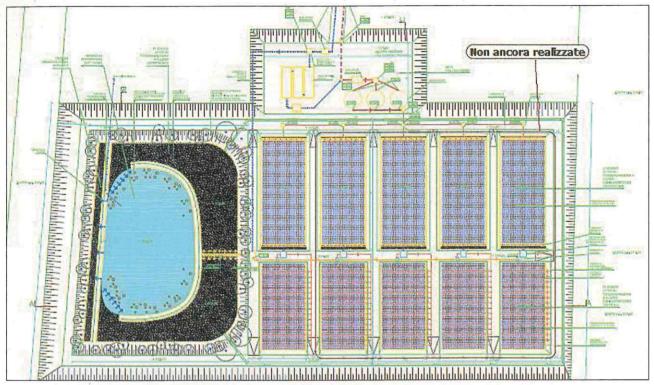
Schema dell'impianto di Vizzola Ticino - Trade Center
